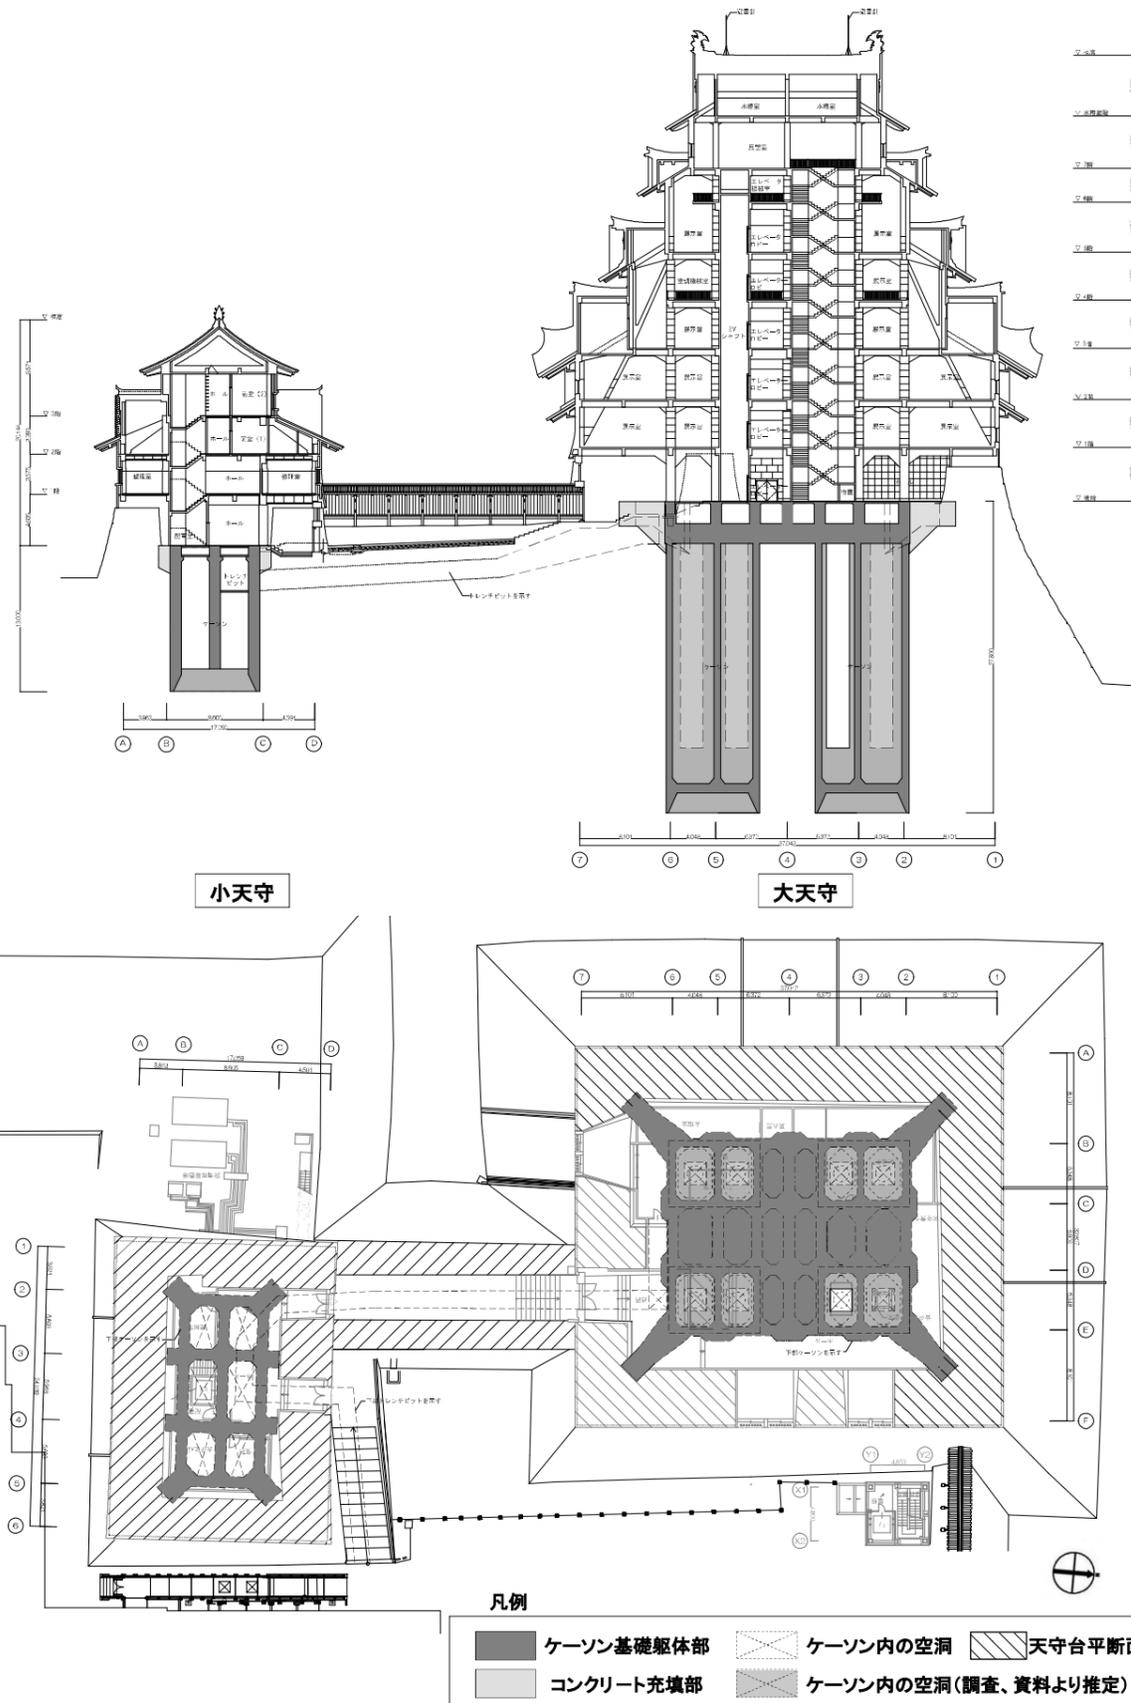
現天守閣ケーソン基礎平面図・断面図
